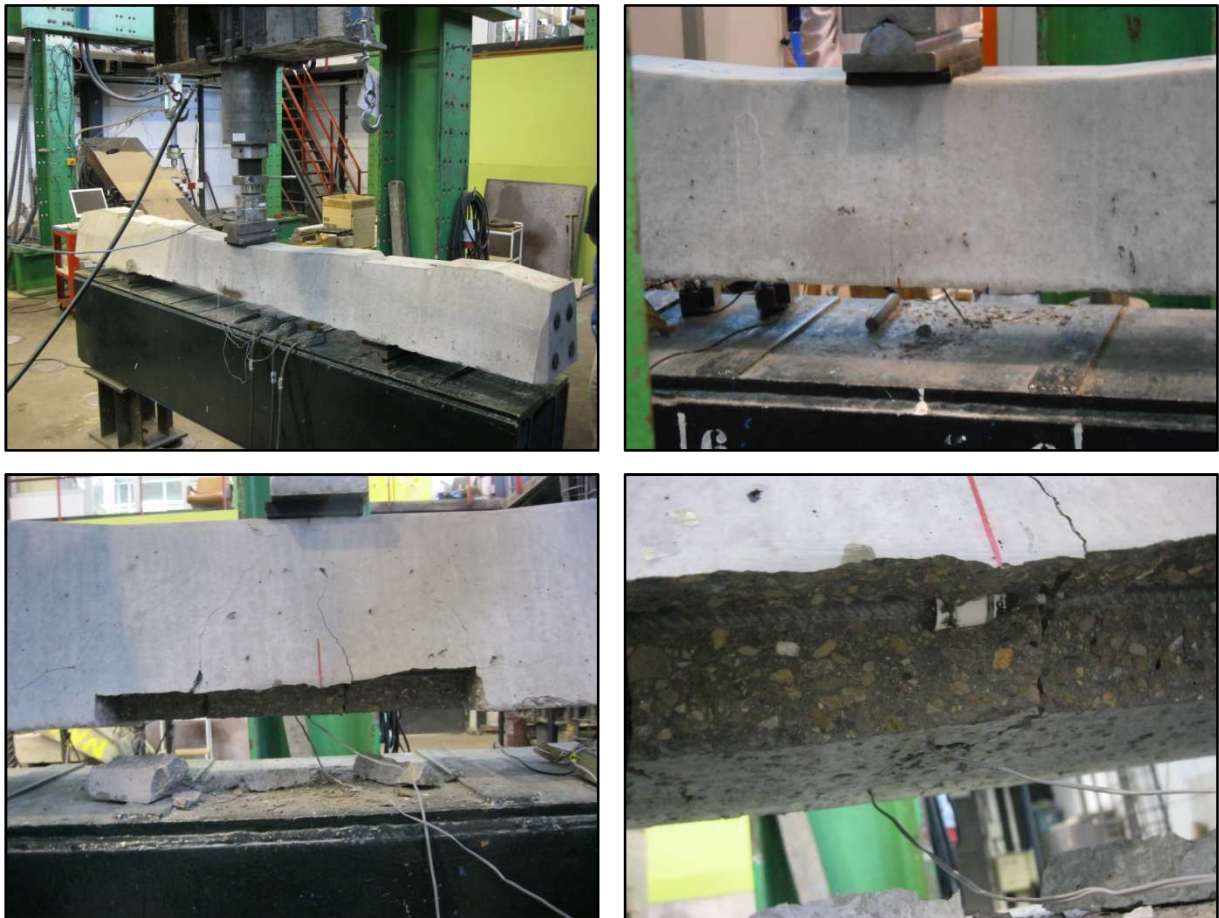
Fotografías del ensayo a flexión positiva en sección central; a) Traviesa ensayada, b) Aparición de la primera fisura, c) Desprendimiento del hormigón, d) Detalle de la galga extensiométrica embebida
